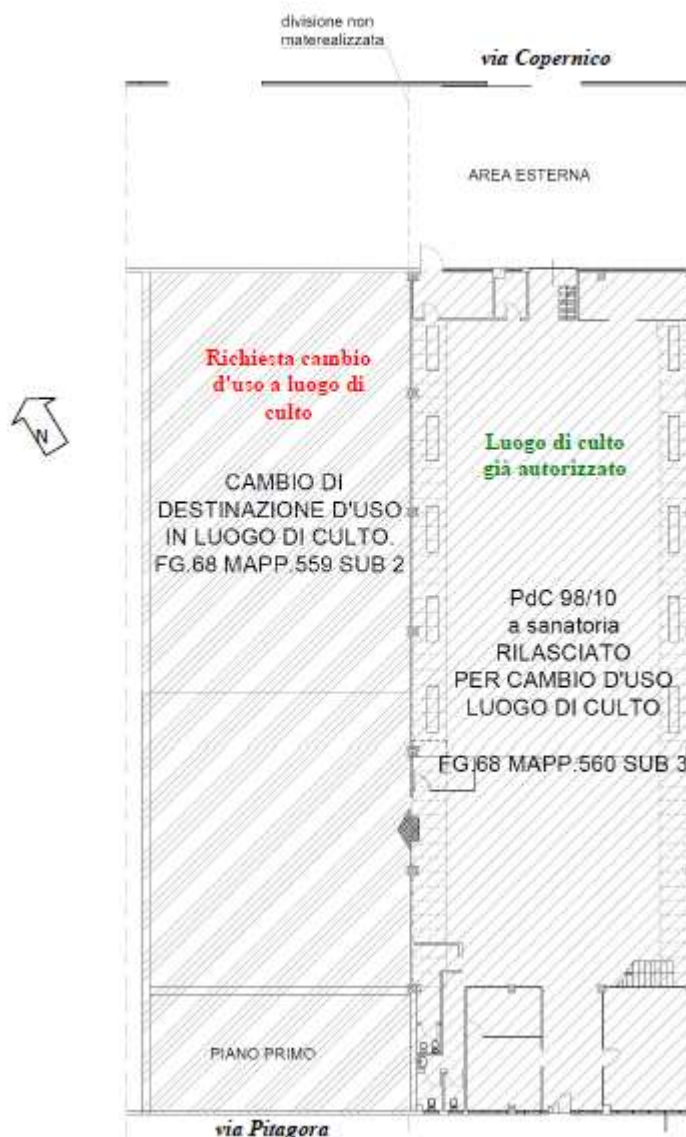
Planimetria con indicazione del luogo di culto già autorizzato e dell'ampliamento oggetto del POC-5.
